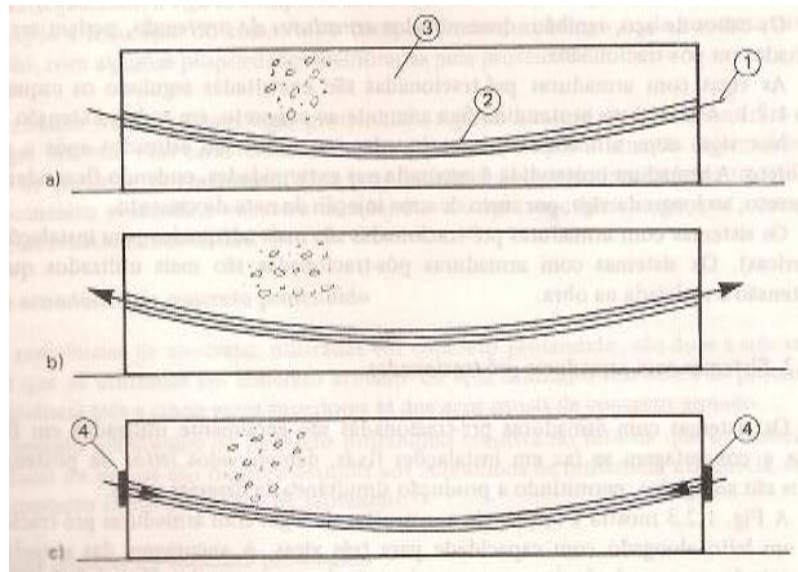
Sequência construtiva de vigas com armaduras pós-tracionadas.
